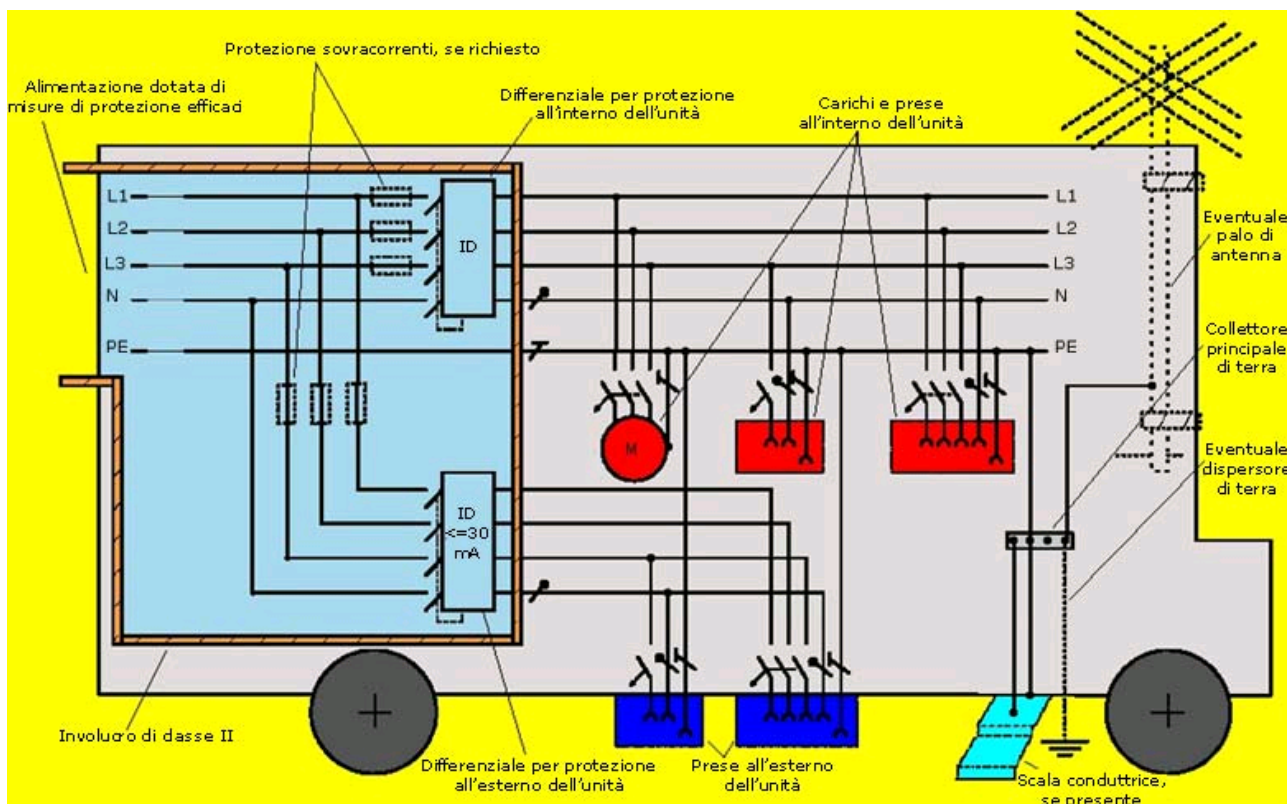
Alimentazione diretta dalla rete e protezione per interruzione automatica dell'alimentazione
